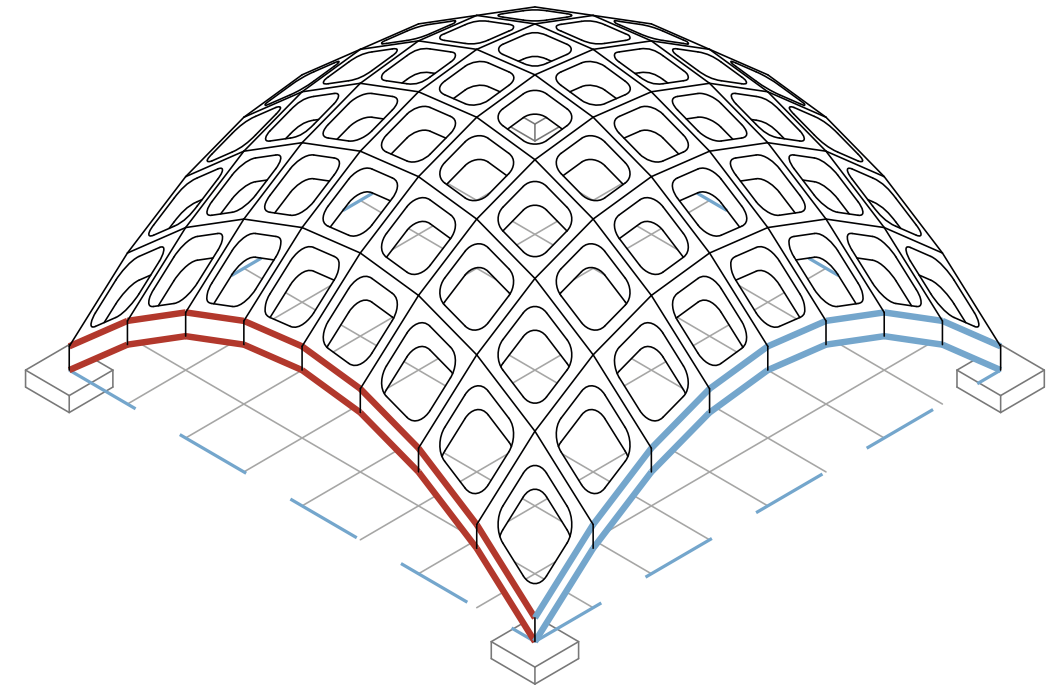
Tragwerk mit quadratischem Grundriss
